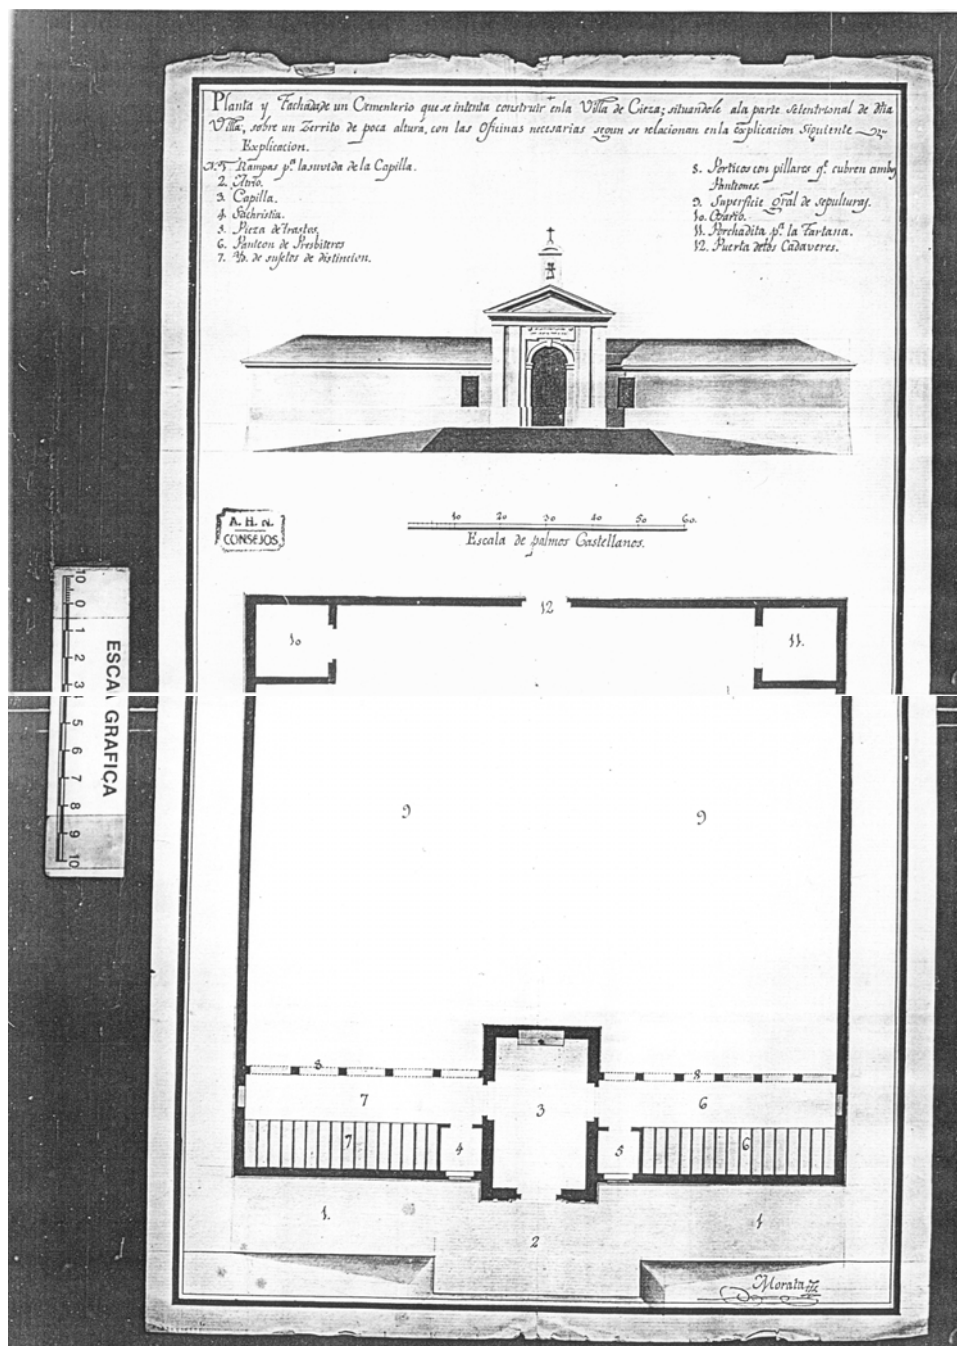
Planta y fachada de cementerio para Cieza. Juan Cayetano Morata. 1806
